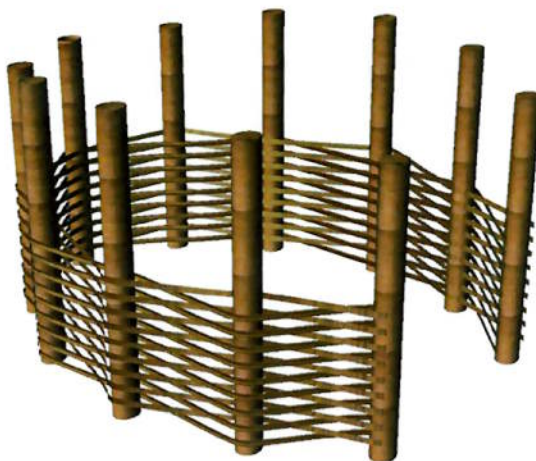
Rendering, perspectiva vigas de apoio e delimitador de espaço
